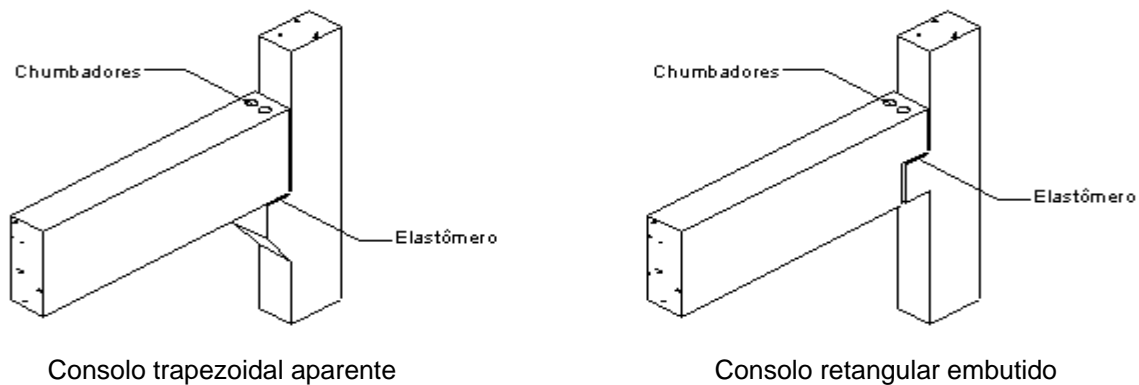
Ligação viga-pilar através de consolo trapezoidal e retangular.
